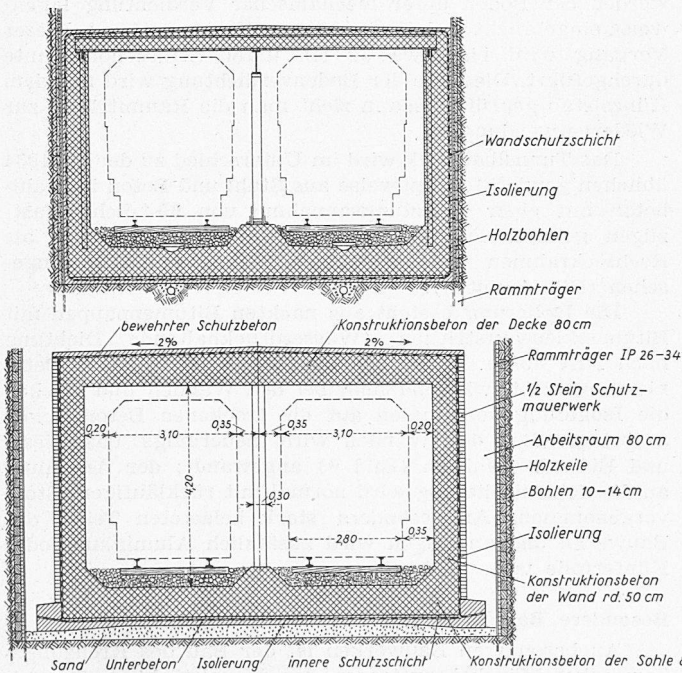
U-Bahn-Tunnelbau in offener Bauweise, Masstab 1:160, Oben Berliner, unten Hamburger Bauweise
